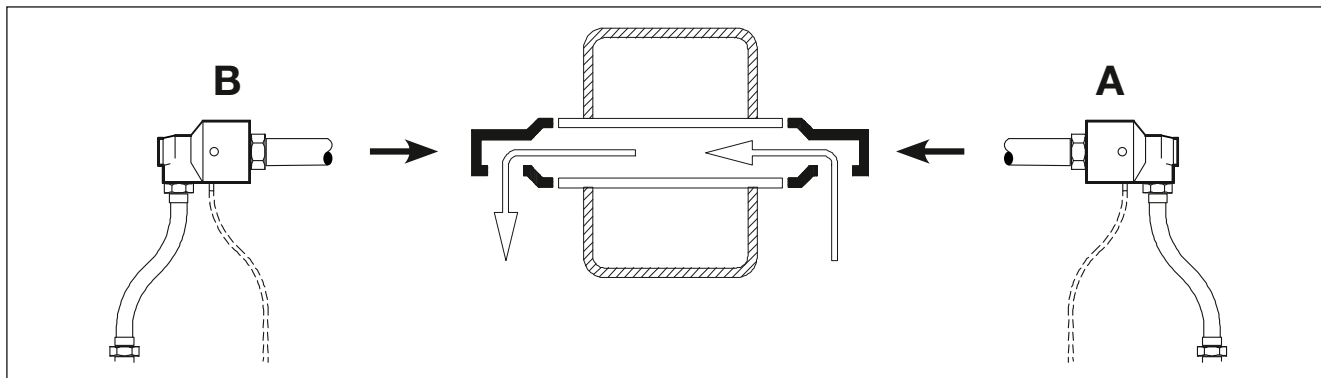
Schema versione ad un passaggio (installazione esterna)
